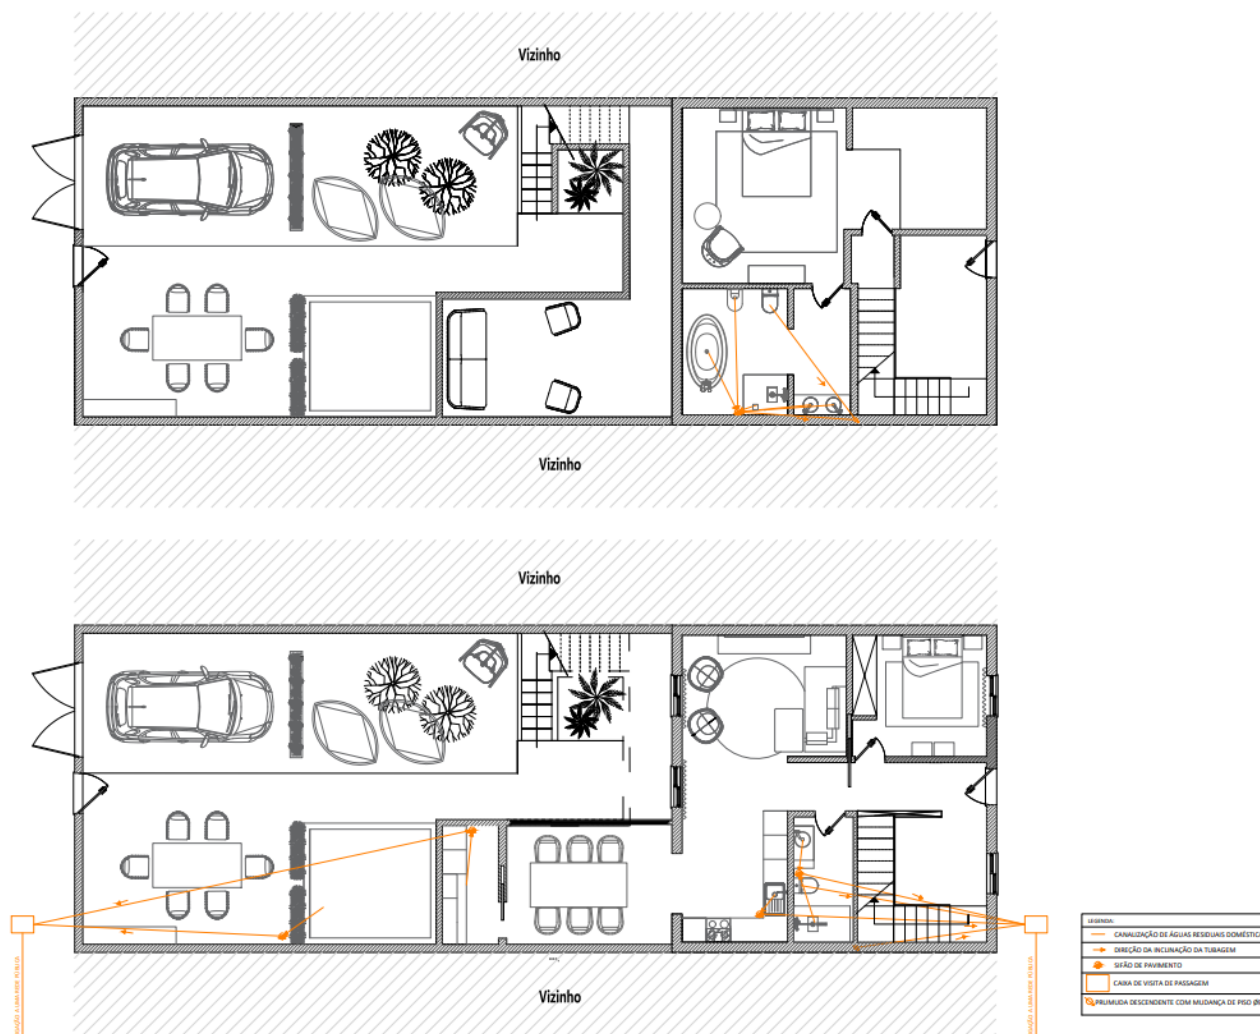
Planta de sistema de drenagem predial de águas residuais, Fonte: Autor
